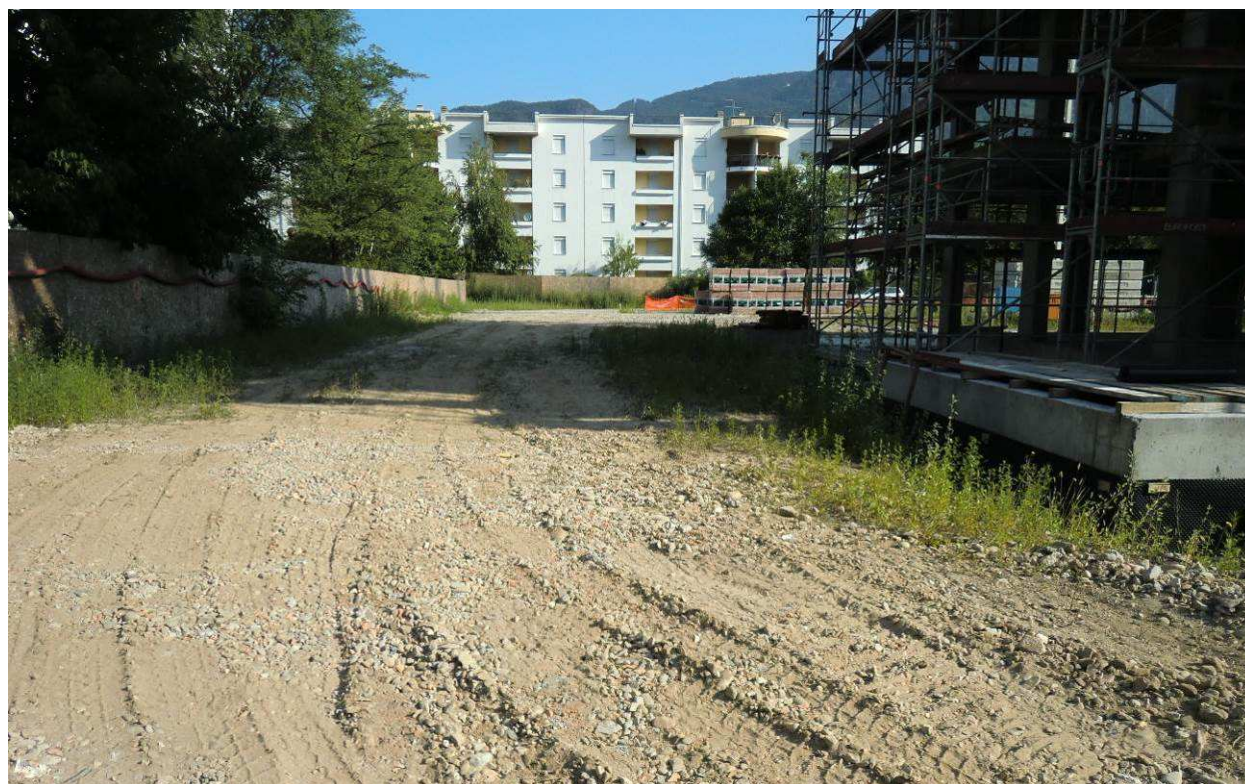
Panoramica dell'area di progetto, vista in direzione NW, sulla destra si intravede una delle prime due palazzine in fase di costruzione
